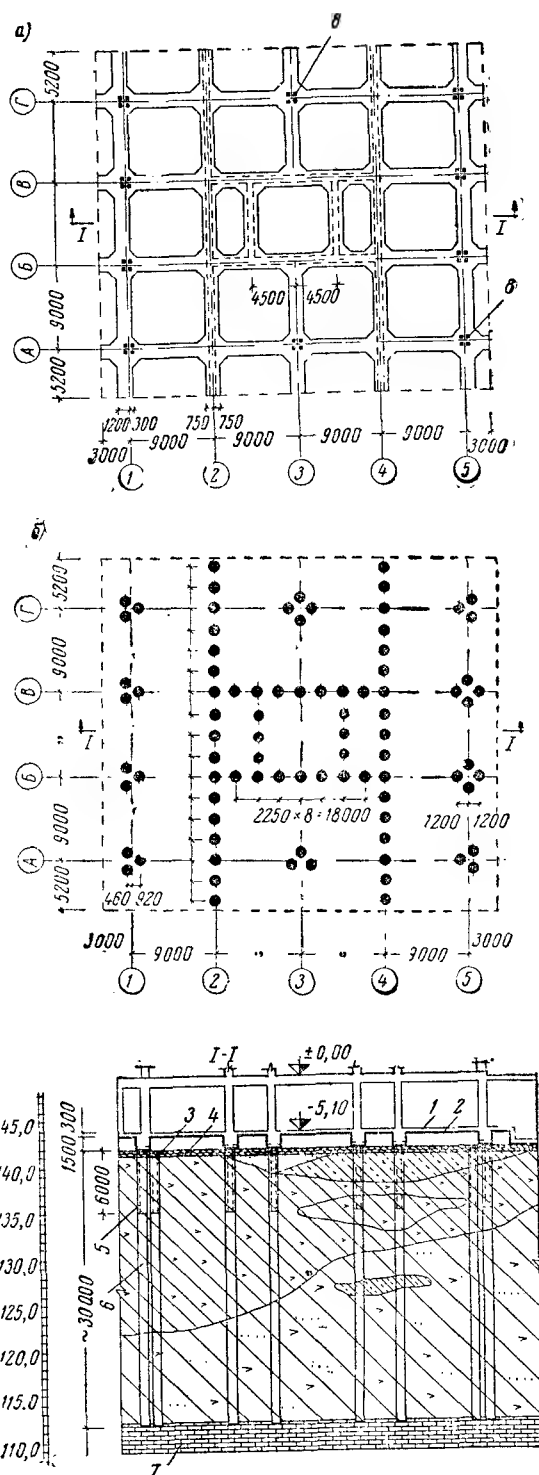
Фундаменты из свай оболочек (глубоких опор)
